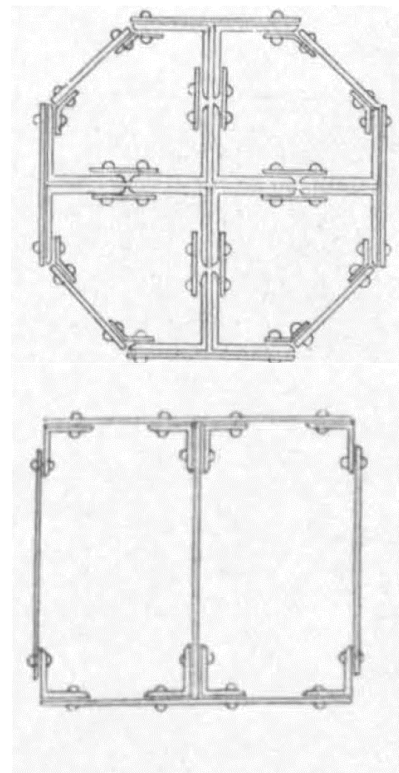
Paul Sédille, Printemps, Detail Pfeilerkonstruktion, Paris, 1885
